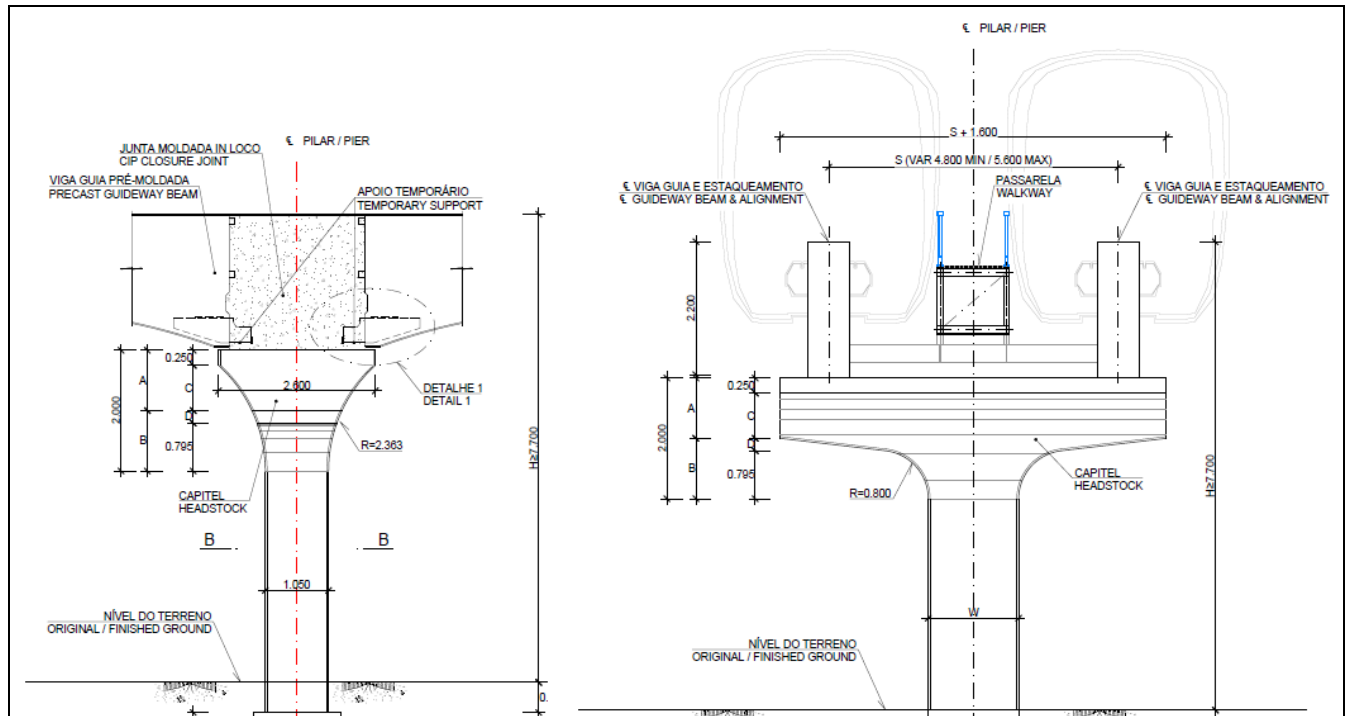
Forma Estrutura Via Elevada Tipo 1A (Planta DE-MG.00.EL_C.EC2-002).
